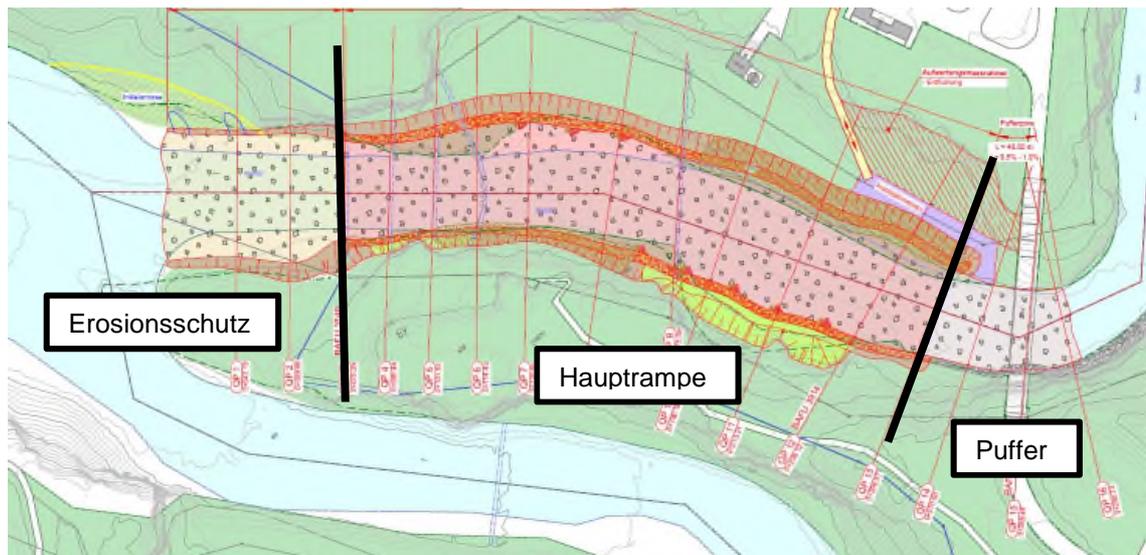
Aufgelöste Blockrampe mit Puffer, Hauptrampe und Erosionsschutz.
